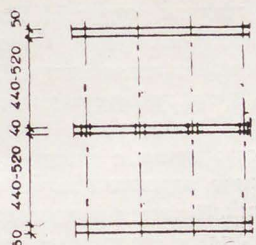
Схема плана здания с одной внутренней несущей стеной при двух одинаковых пролетах
